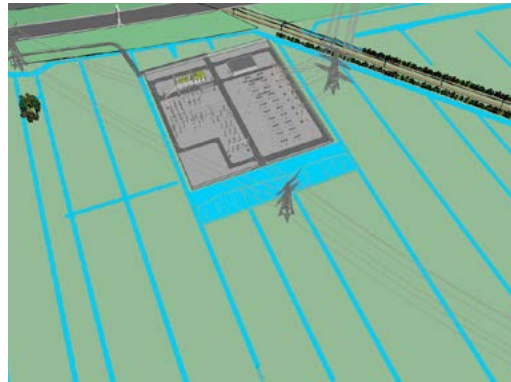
Inpassing door het aanbrengen van een wegbeplanting bestaande uit laanbomen en struweel
